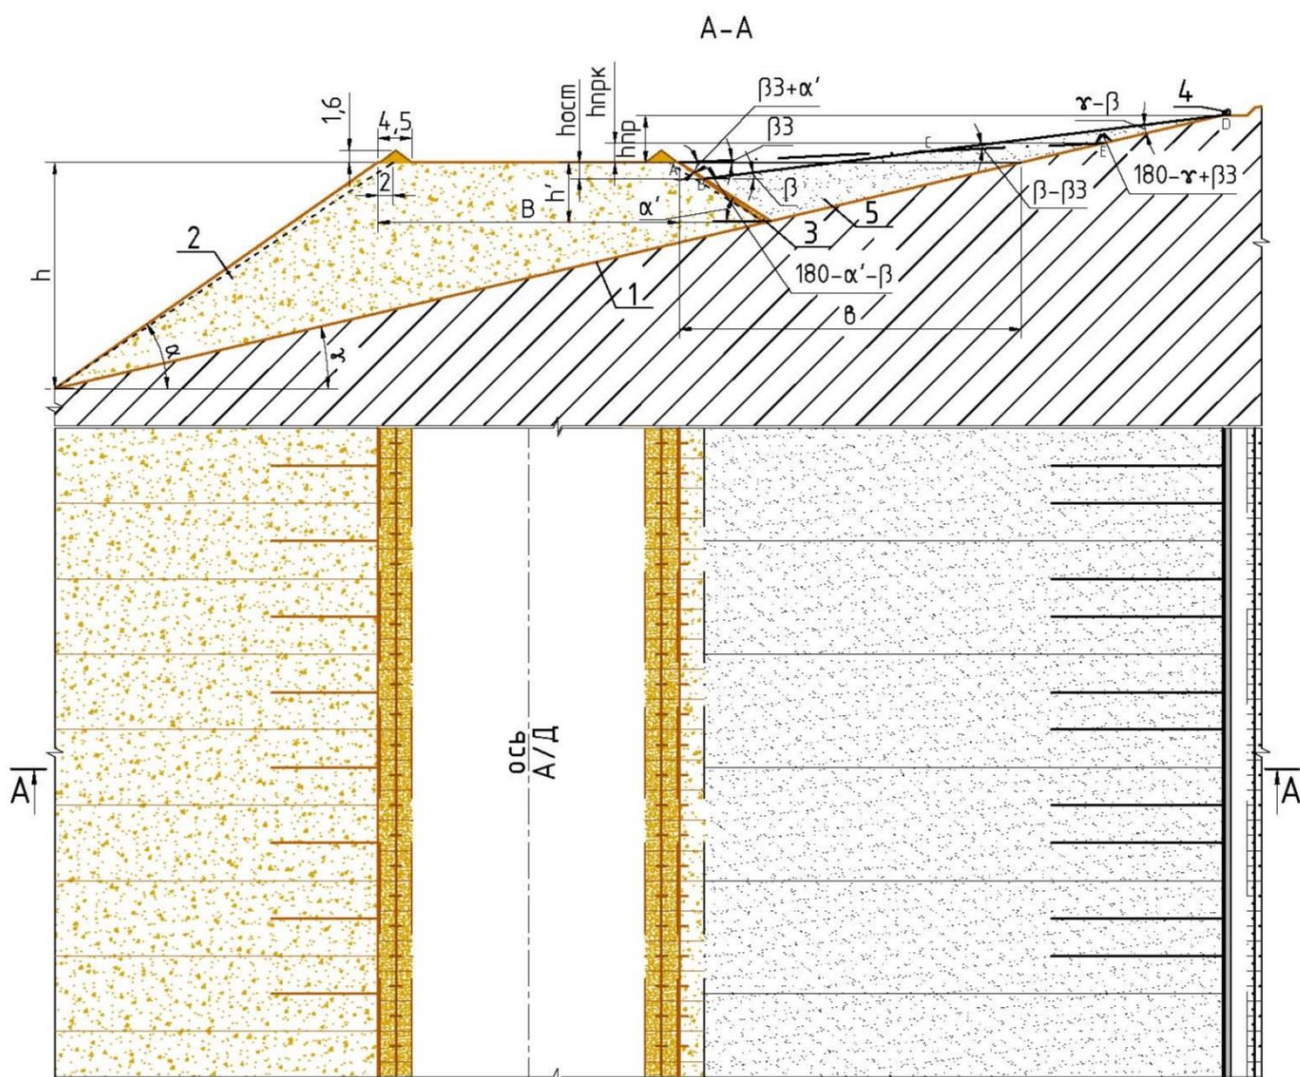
Технологическая схема складирования ПО на наклонном основании со стороны склона с превышением выпуска над уровнем верхней площадки насыпи вскрышных пород:
